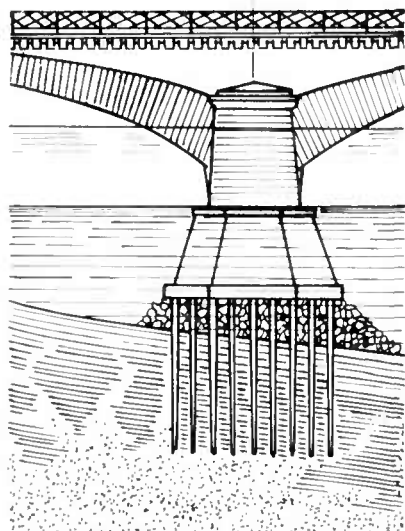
Fondation sur pieux courante avec blocage par des enrochements.
